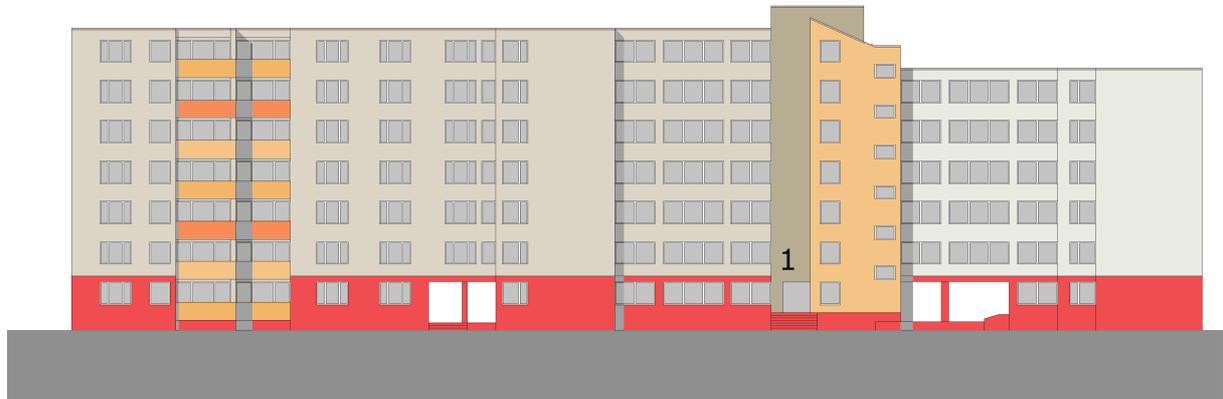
Alternative Lösungsansätze Fassadengestaltung
